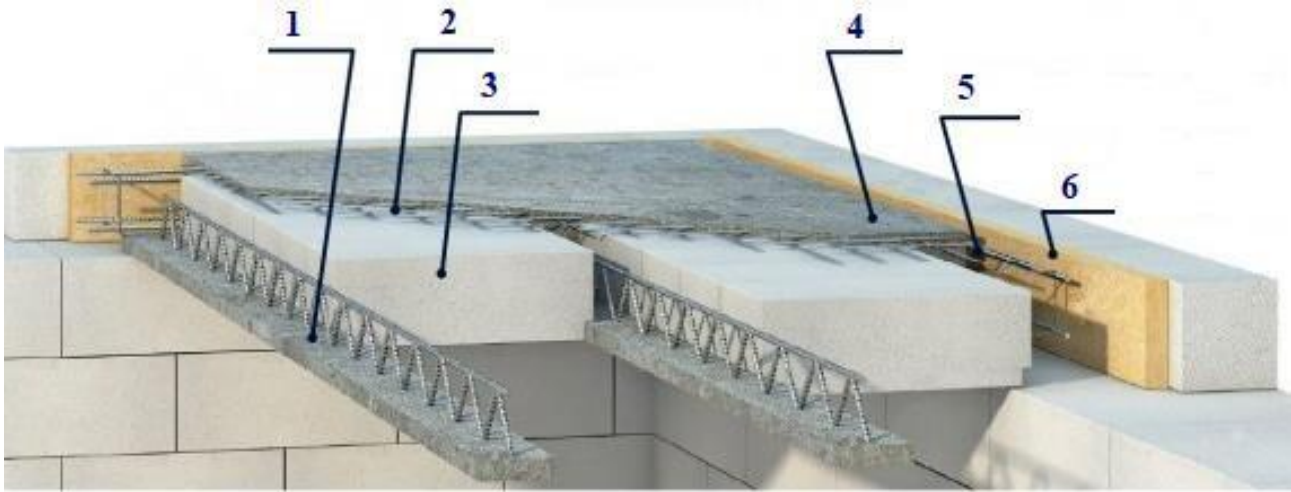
Збірно-монолітне перекриття (1- несуча балка; 2 – арматурна сітка; 3 – пустотілий блок; 4 – бетон С12/15; 5 – направляюча арматура; 6 - утеплювач)
